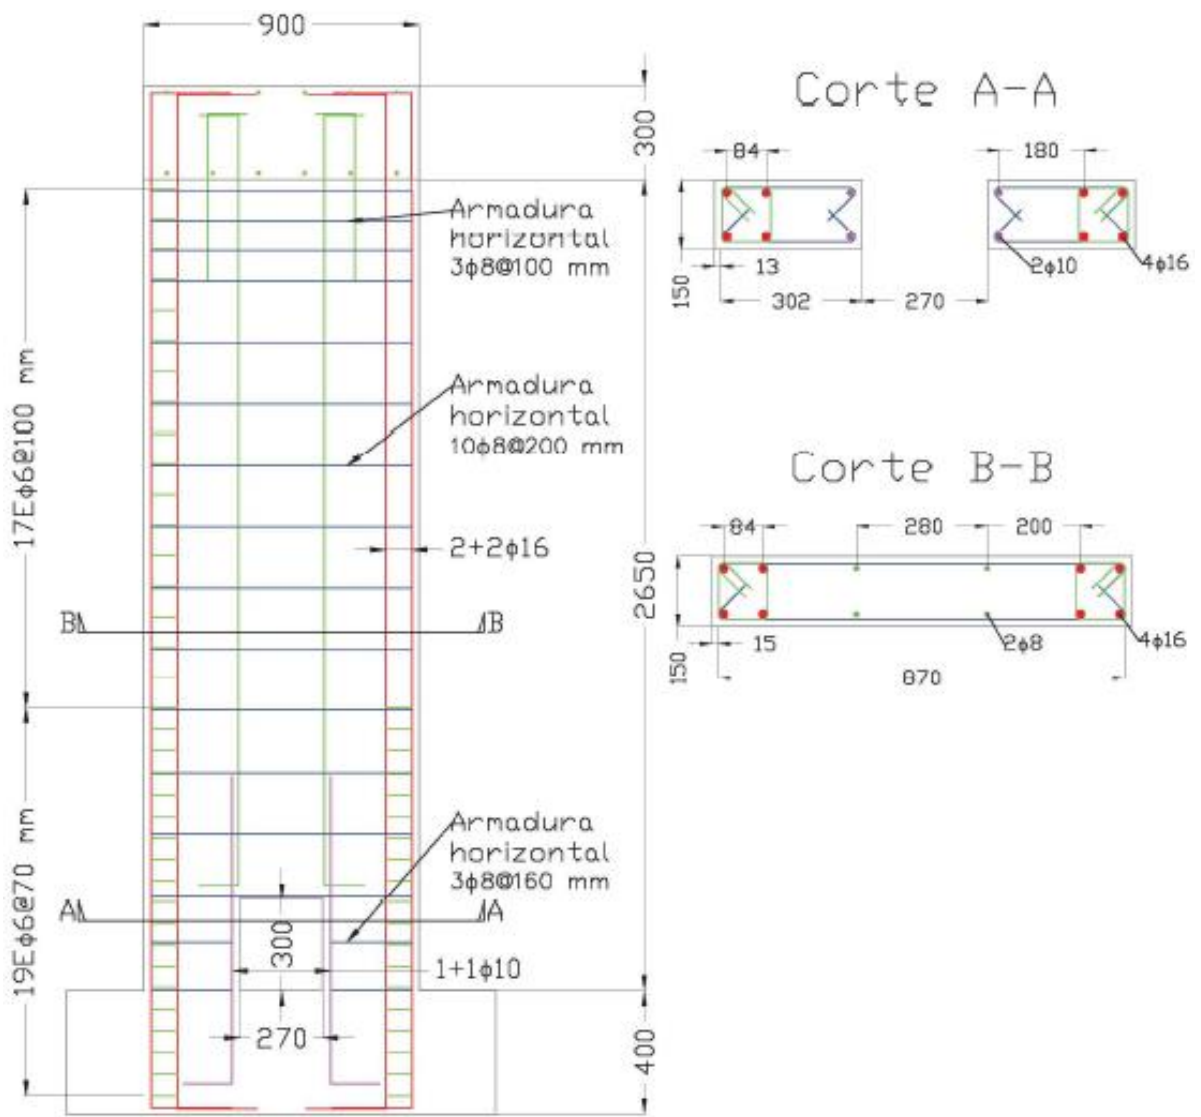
Detallamiento de la armadura de la probeta 2 de muro con abertura.
